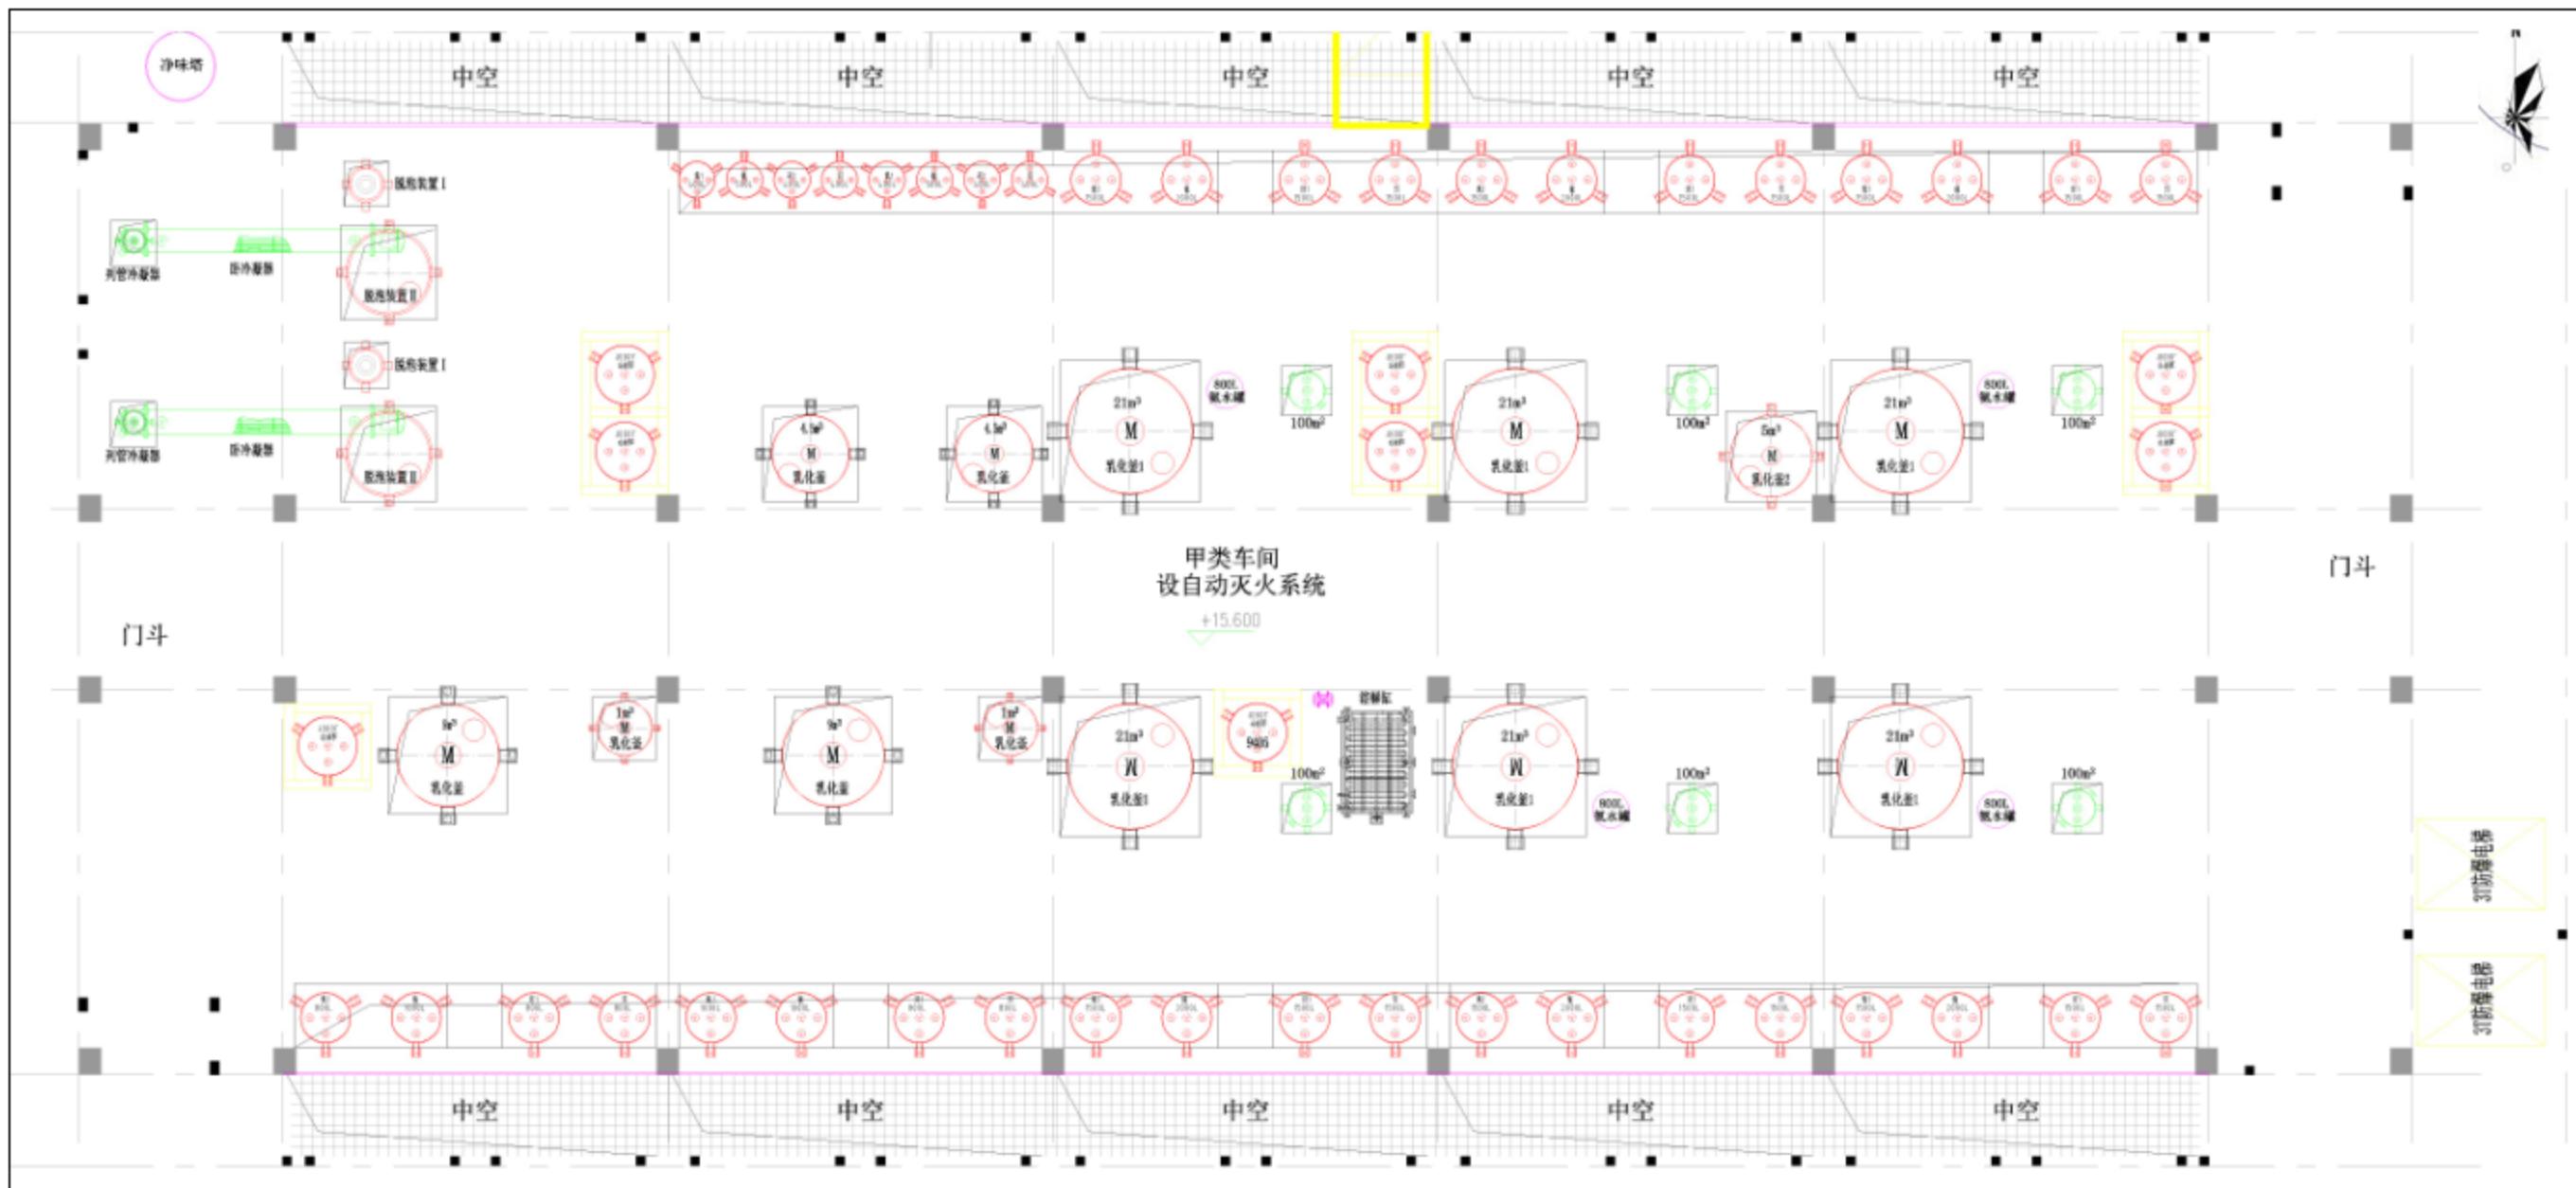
甲类车间B4层平面布置图(比例尺1:100)
